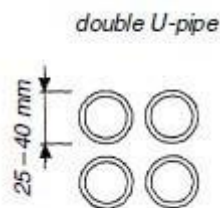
Sonda geotérmica en doble U.
